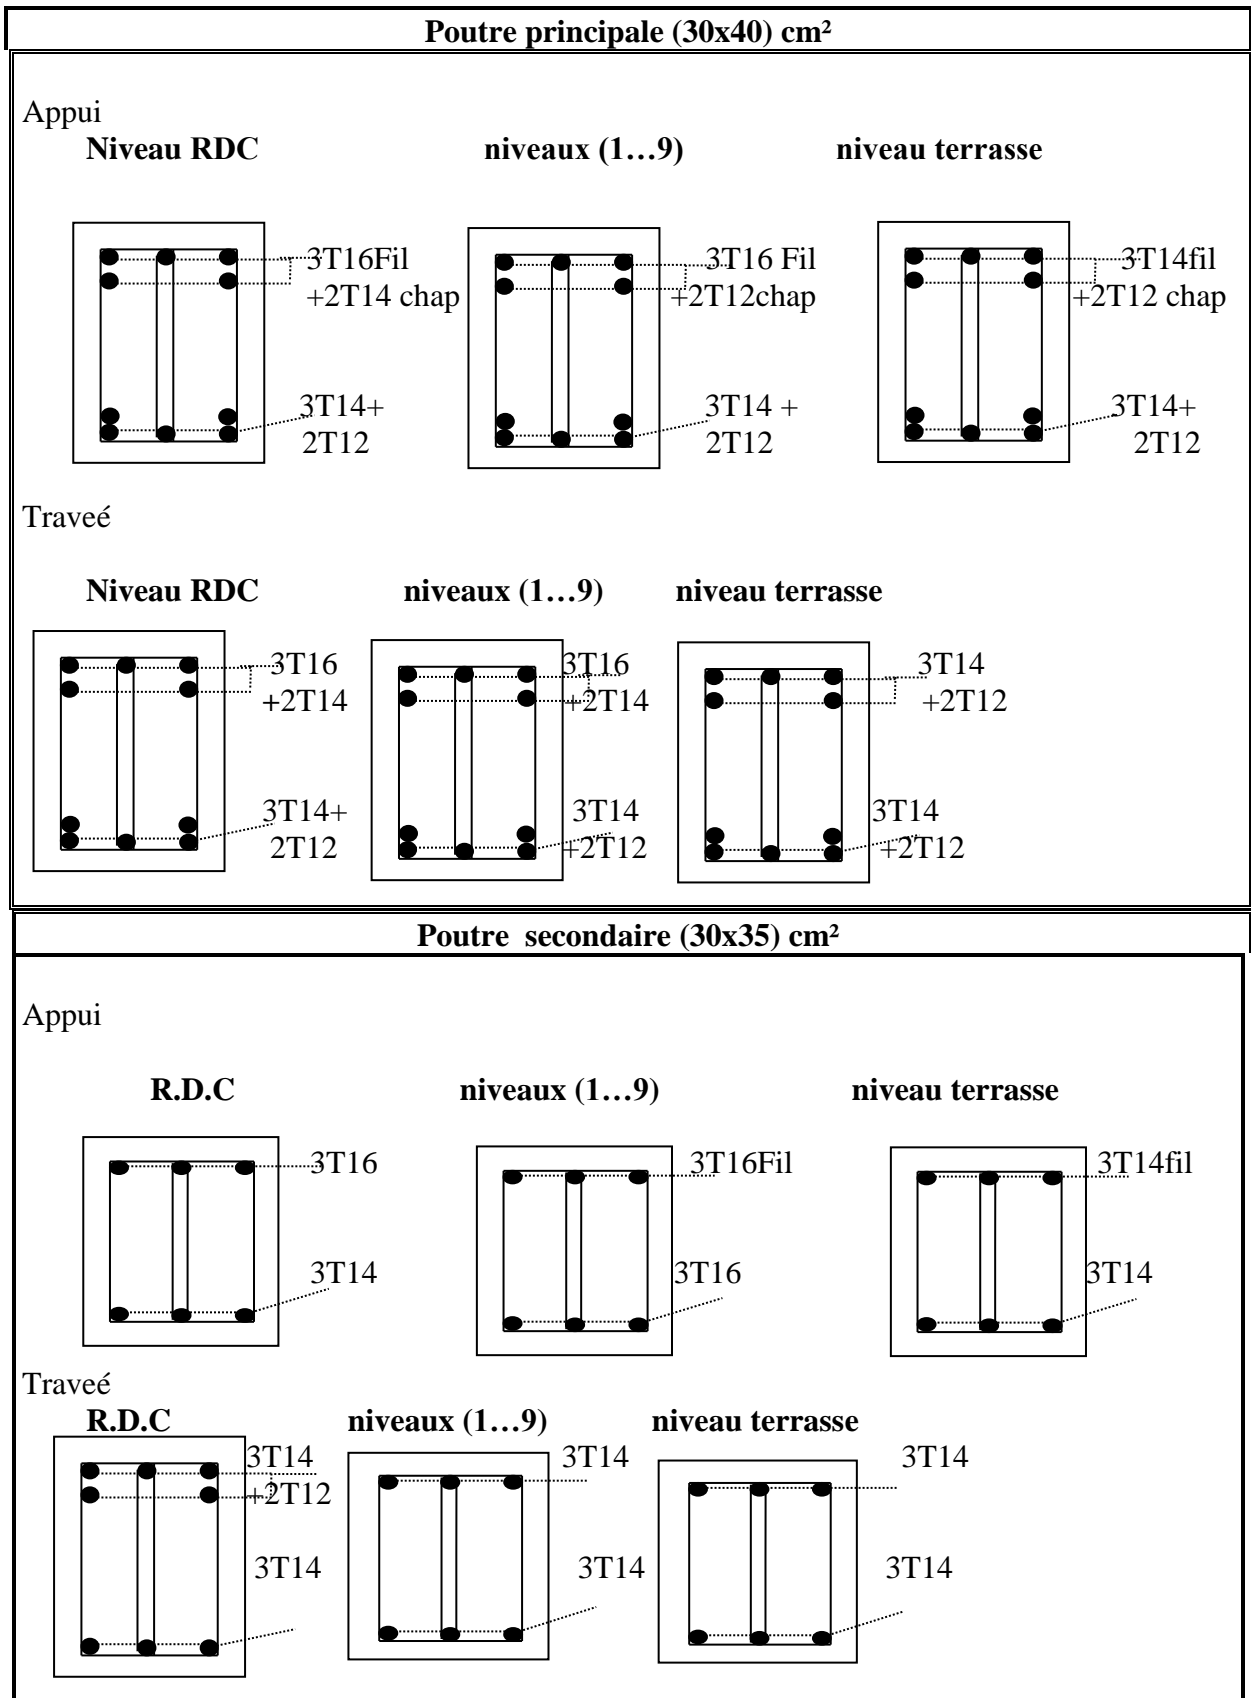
Schéma des ferrailages des sections des poutres principales et secondaires
